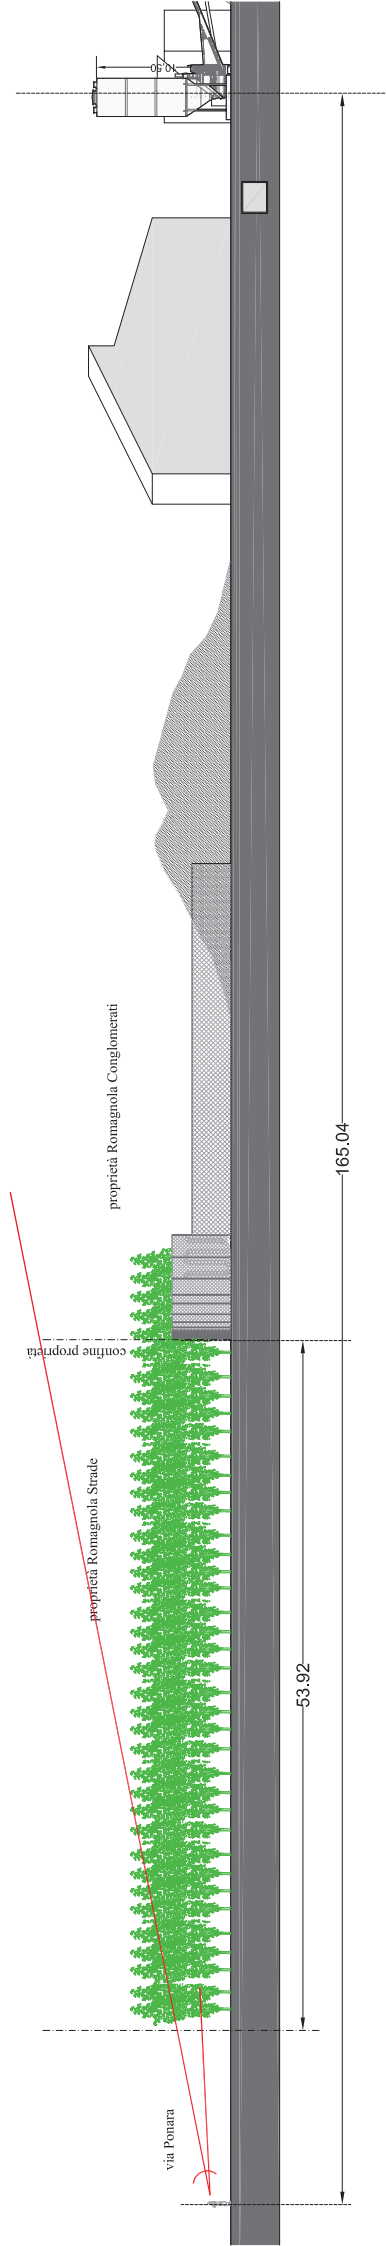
VISTA DELLO STABILIMENTO DALLA VIA PONARA
